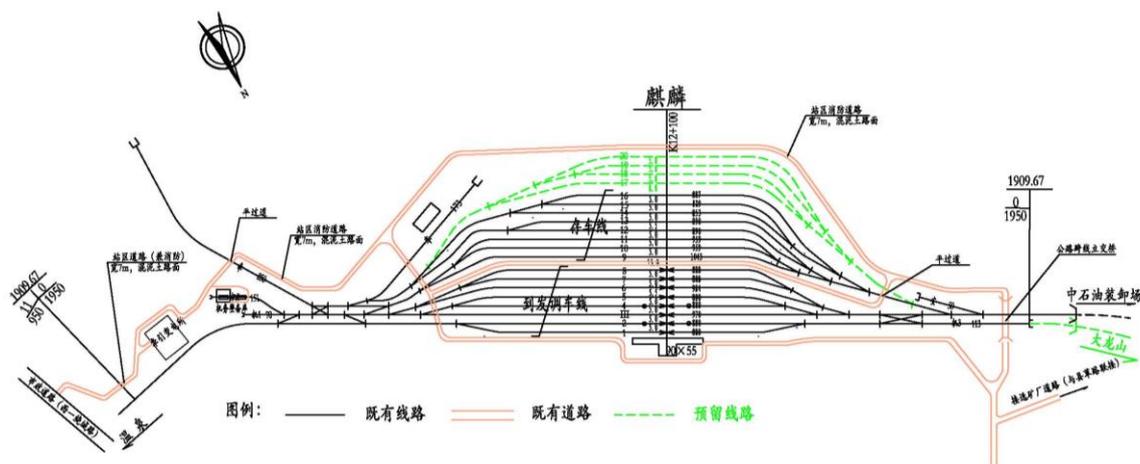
新亚美谷专用线麒麟场平面示意图
